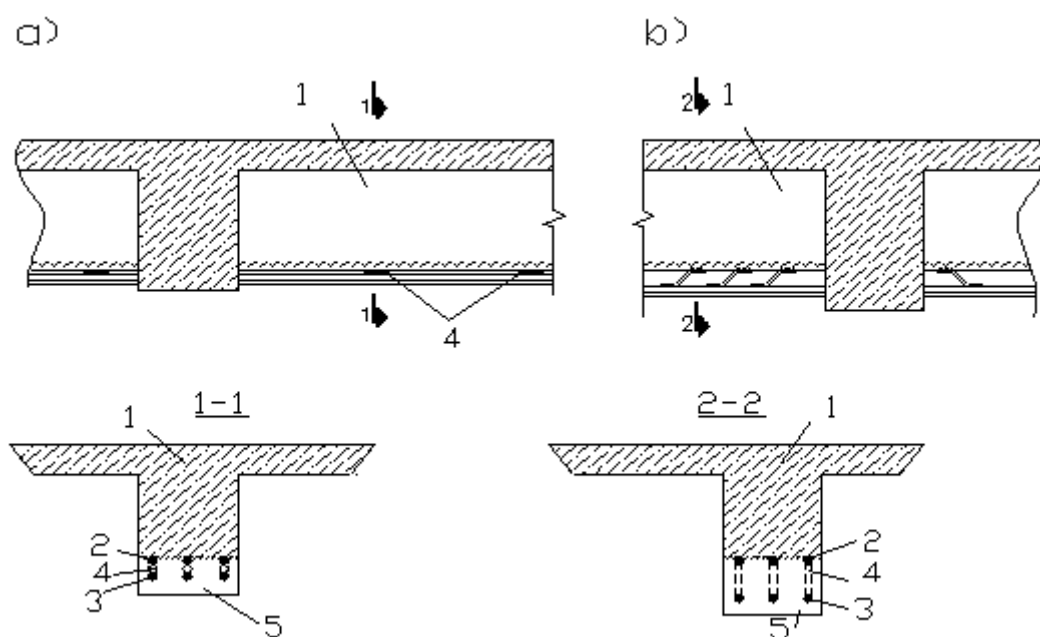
Усиление балки монолитного перекрытия односторонним наращиванием.
